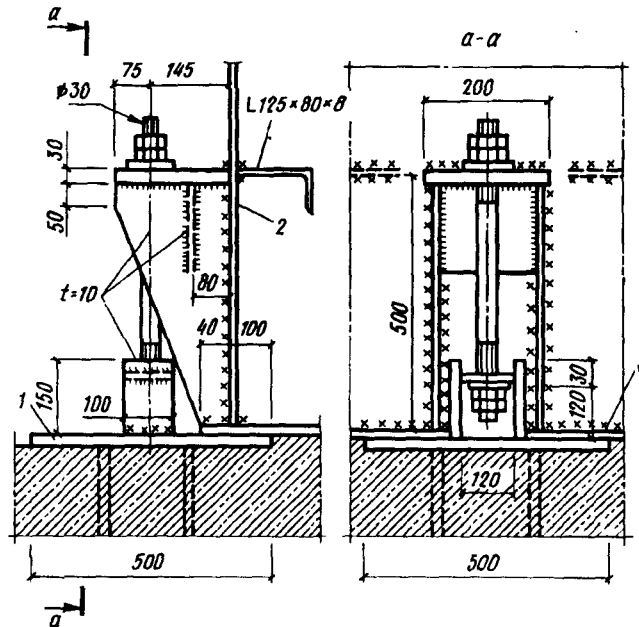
Узел сопряжения стенки корпуса резервуара с дном
